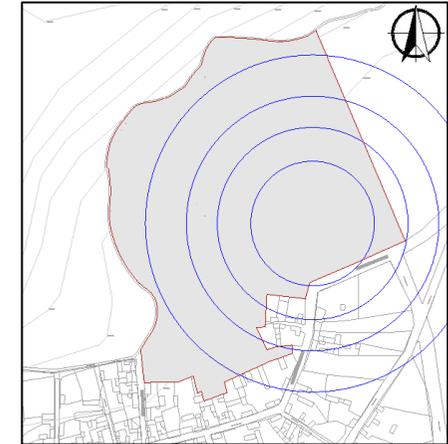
Se muestra el eje organizador en planimetría. Elaboración propia.
